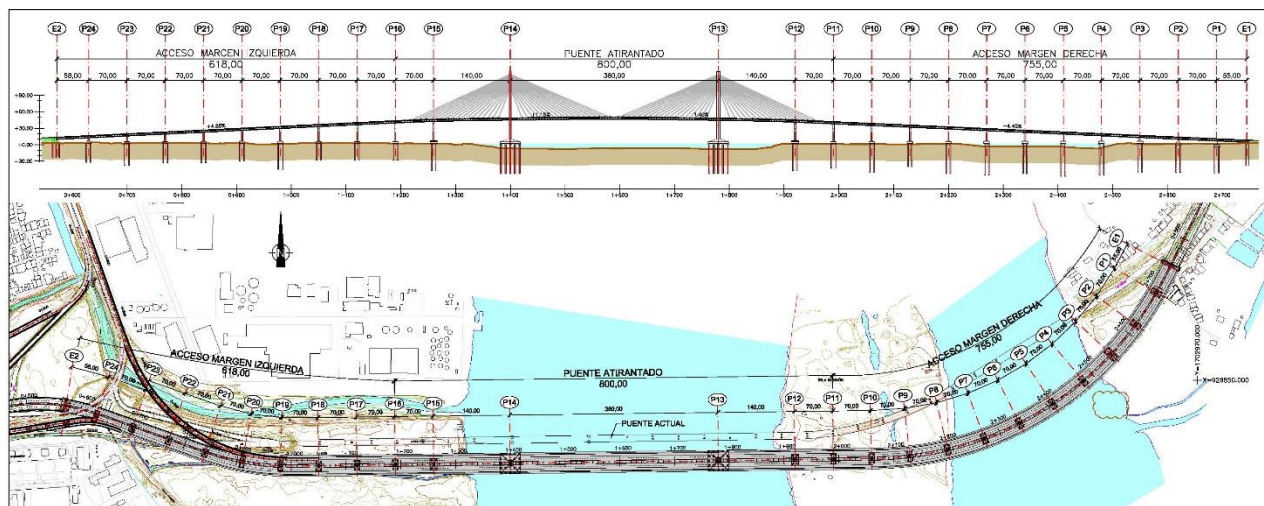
Alzado y planta del Nuevo Puente Pumarejo sobre el río Magdalena
